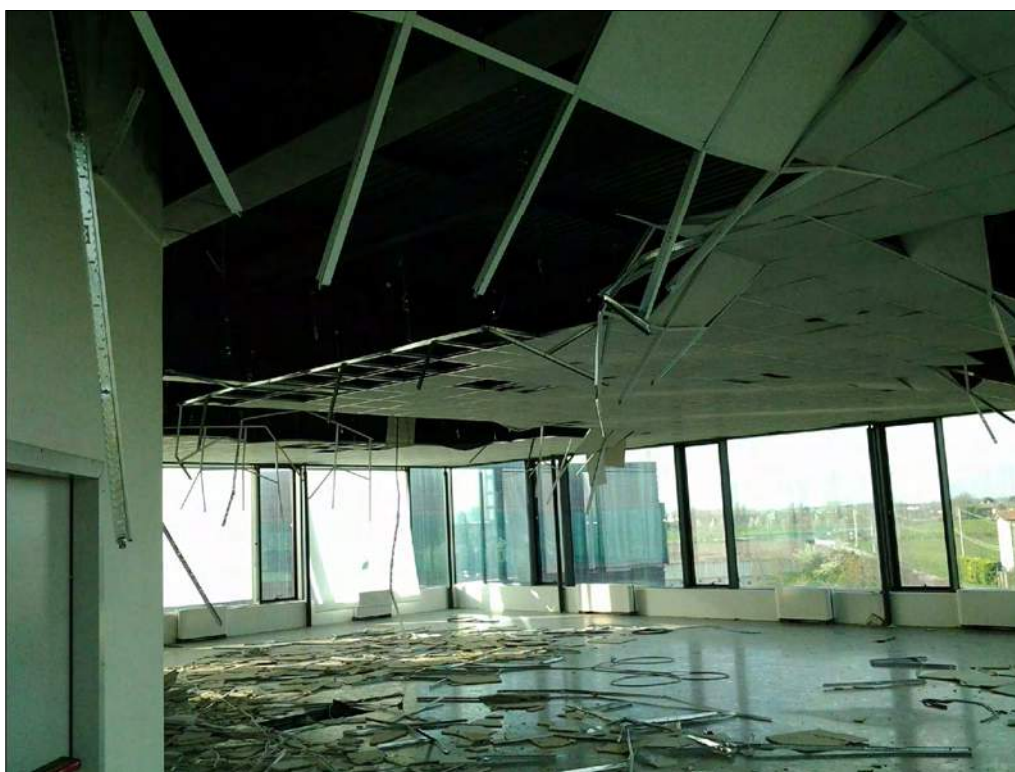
Locale ad uso industriale-artigianale al primo piano lato EST, oggetto di atti vandalici
